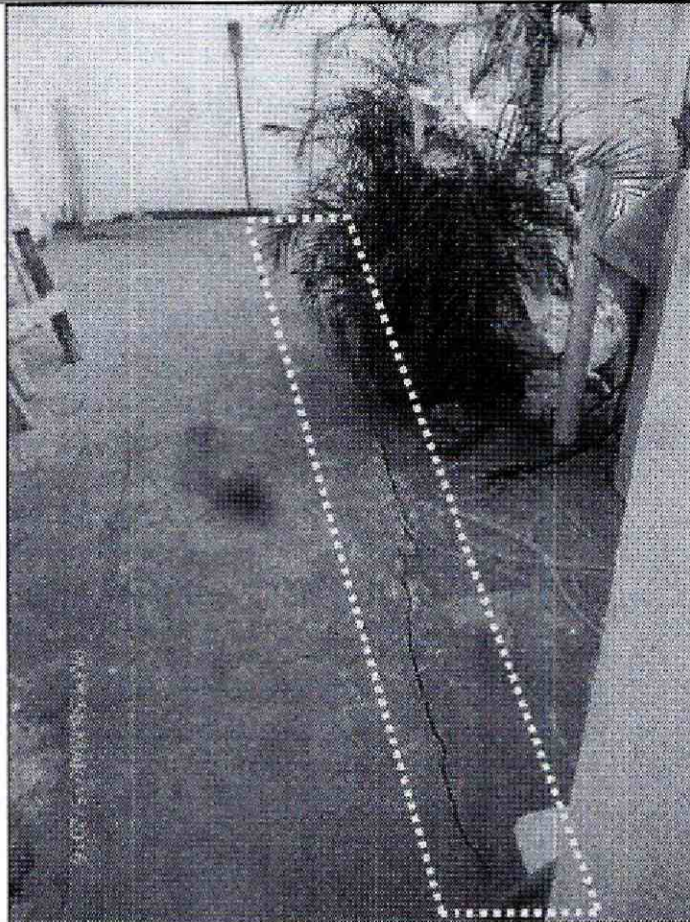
Grietas de tendencia vertical en muro de cerramiento del costado norte de la vivienda ubicada en el predio de la Calle 84 No. 21 – 26, en el Sector Catastral Polo Club de la Localidad Barrios Unidos.
